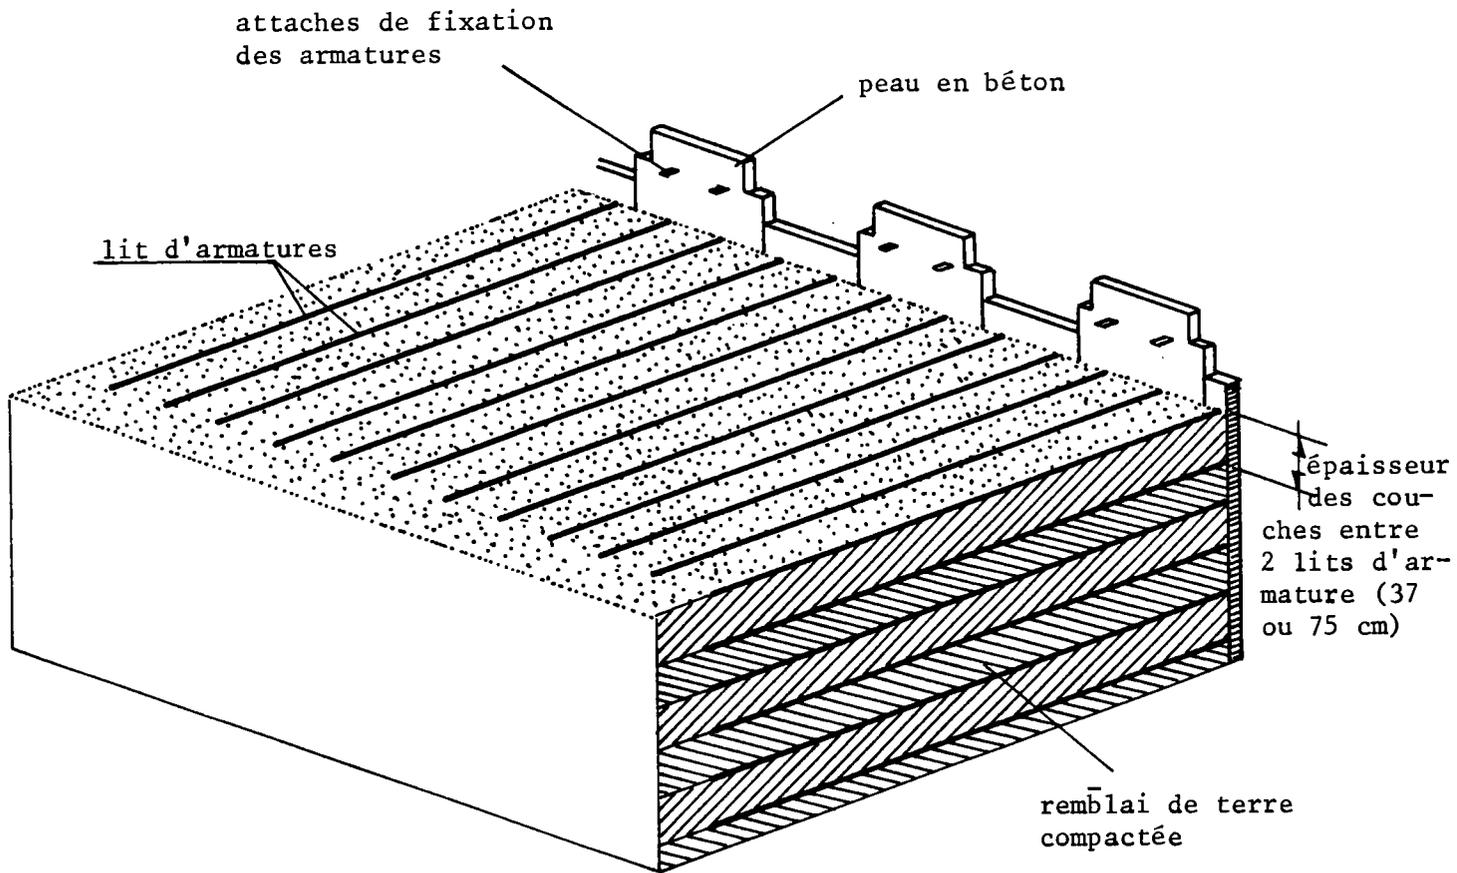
Schéma d'un mur en terre armée en cours de construction.
